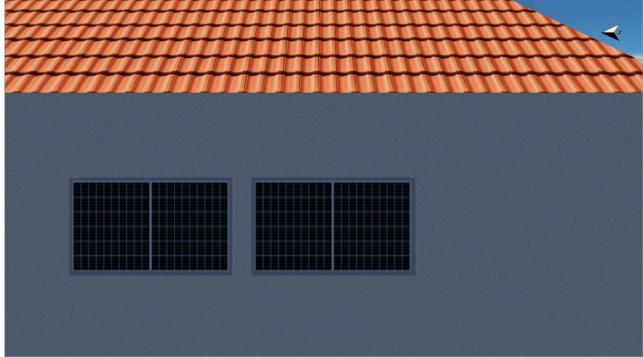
Modulfläche - Gebäude 01-Fassade West
